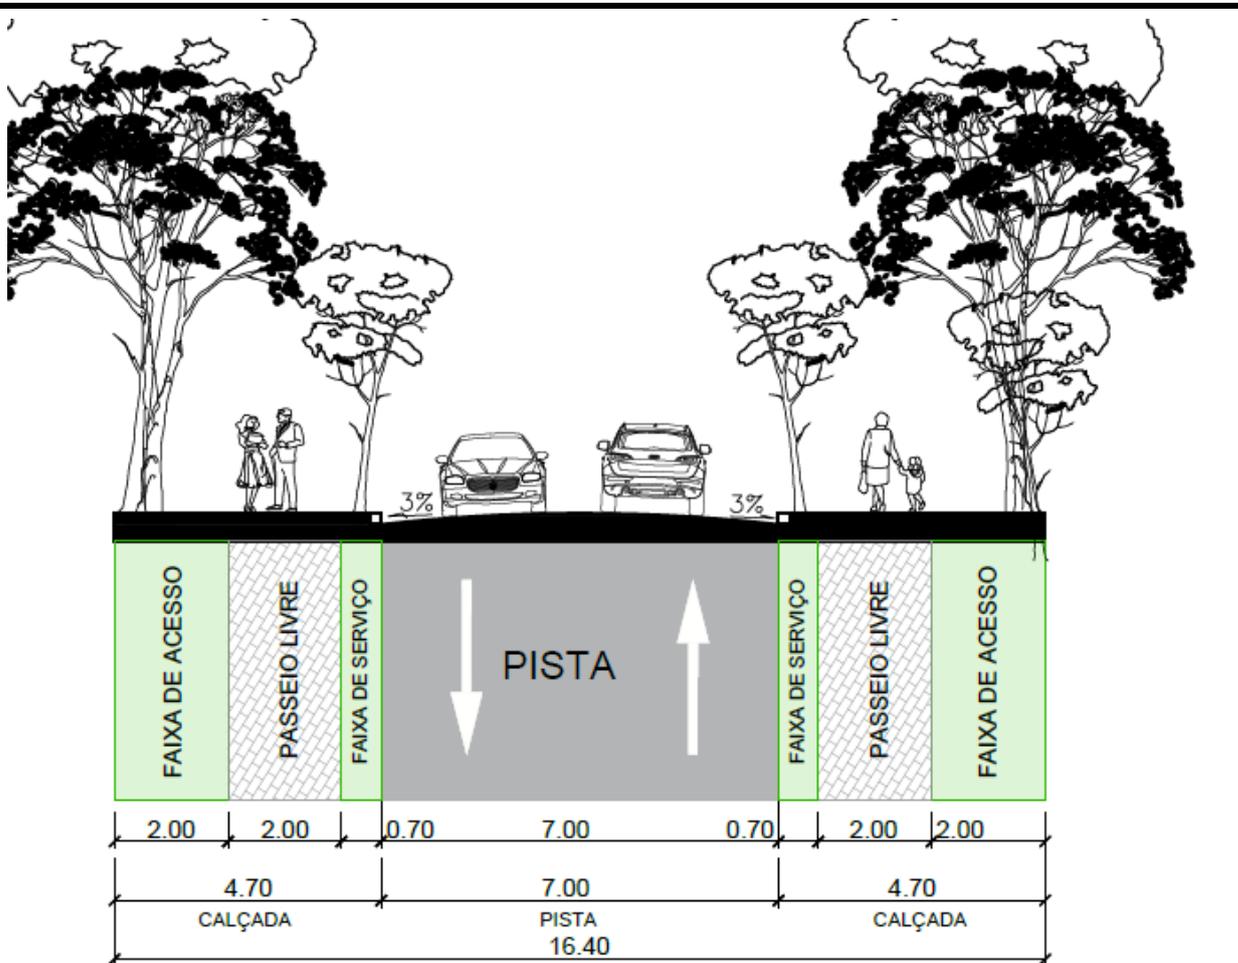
Perfil 13 – Travessas Cajuí, Cipó e Ariri.
